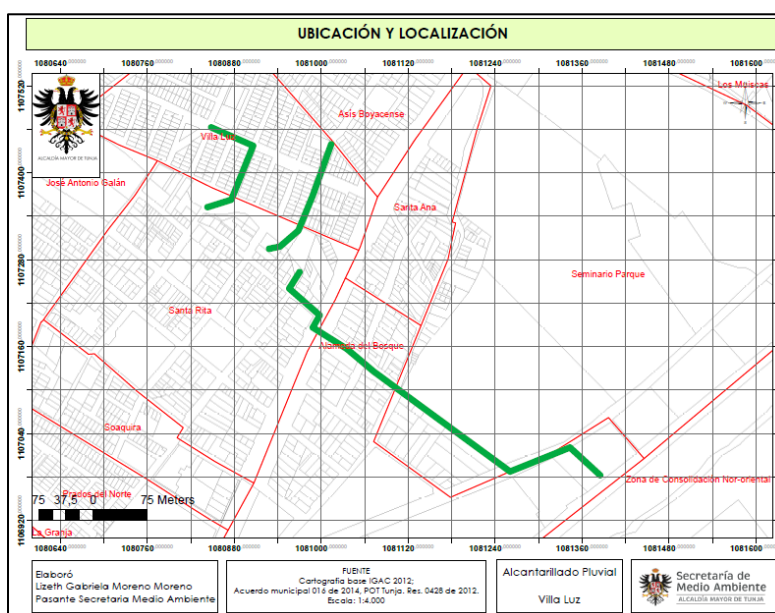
Alcantarillado pluvial Villa Luz, Descole, cabezal de descarga, colector 1 y 2 cabezote carrera 6ª con 59, canal de descarga vía férrea y canal a río Jordán
